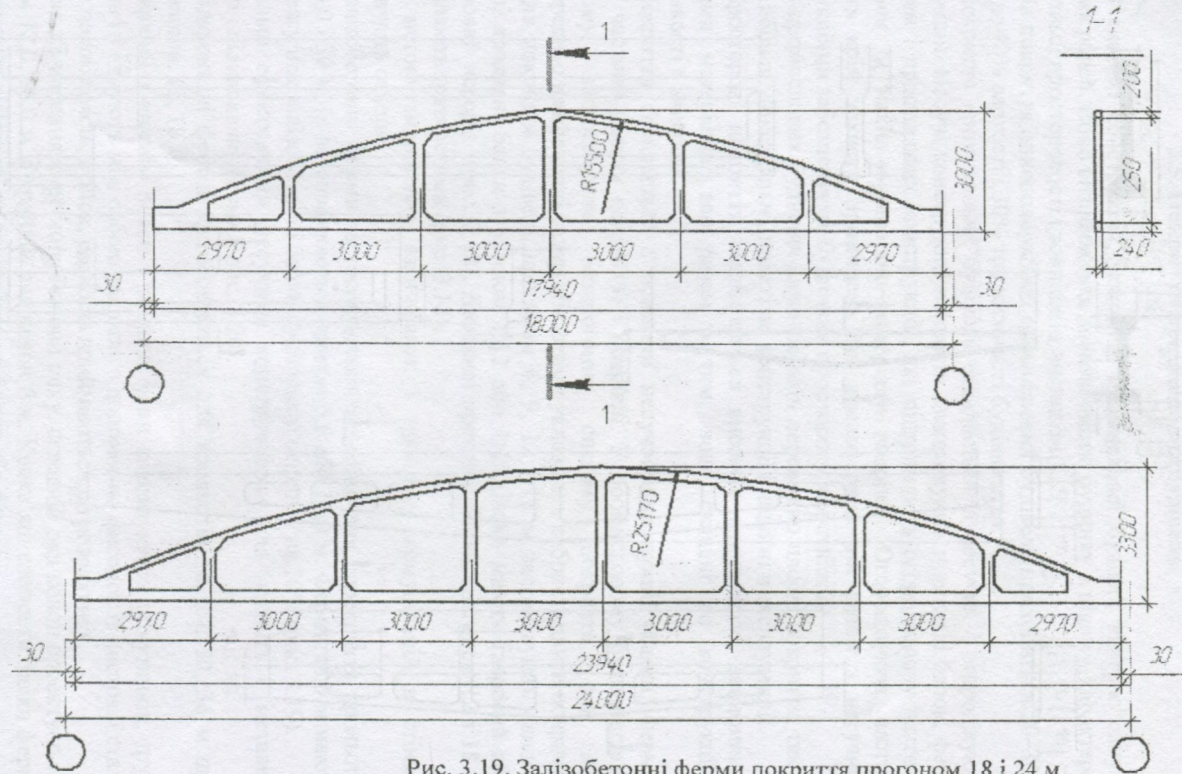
Залізобетонні ферми покриття прогоном 18 і 24 м
